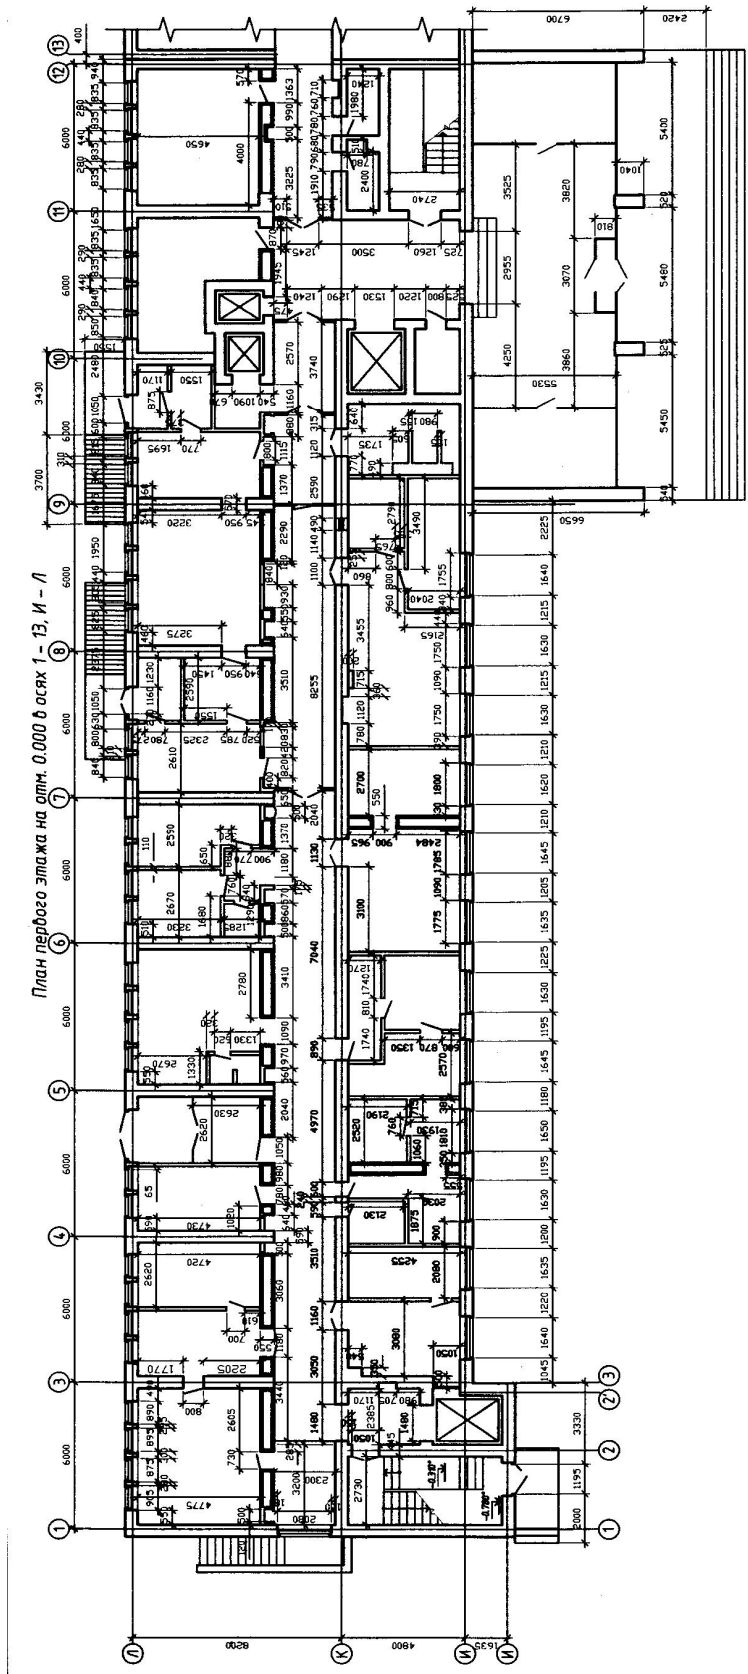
Фрагмент плана первого этажа здания больницы
